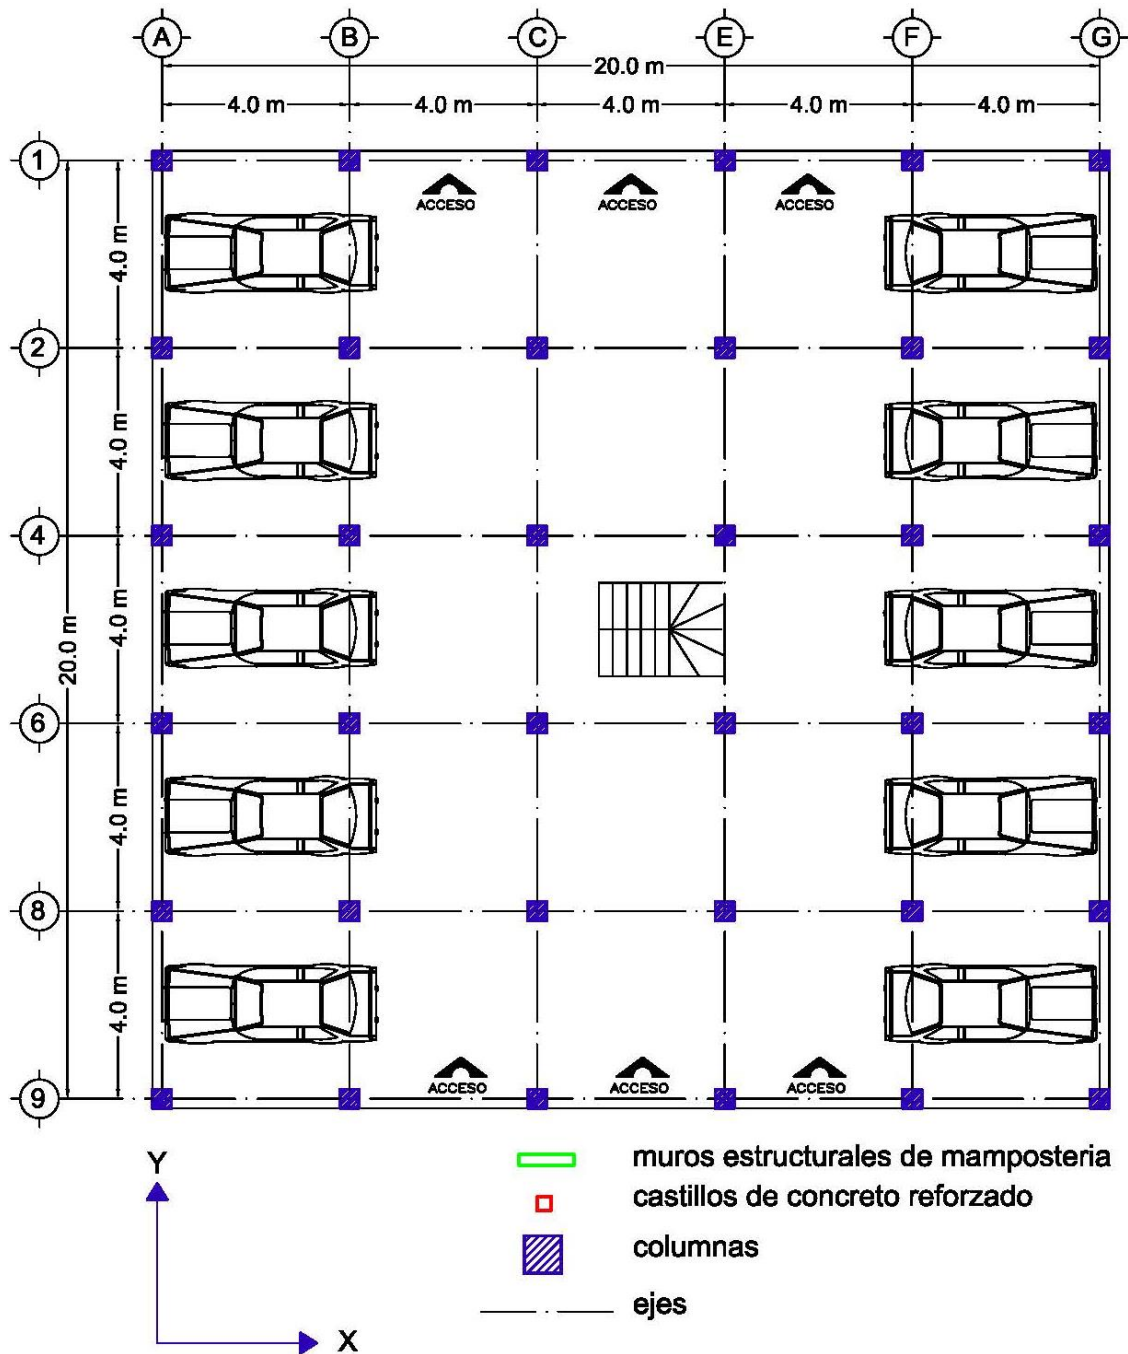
Planta arquitectónica de los niveles superiores, modelo M1.
